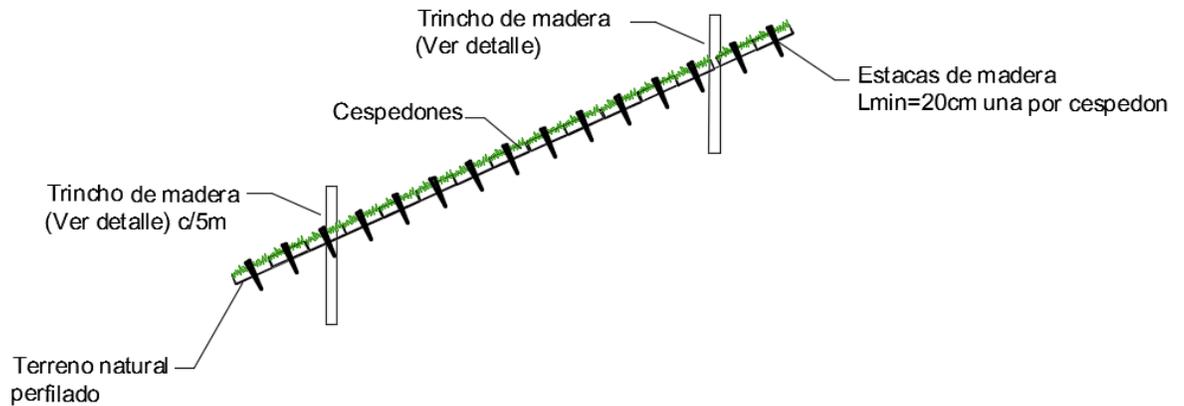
Vista en planta obras k2+600. Fuente: Diseños UT CONSULVIALES
